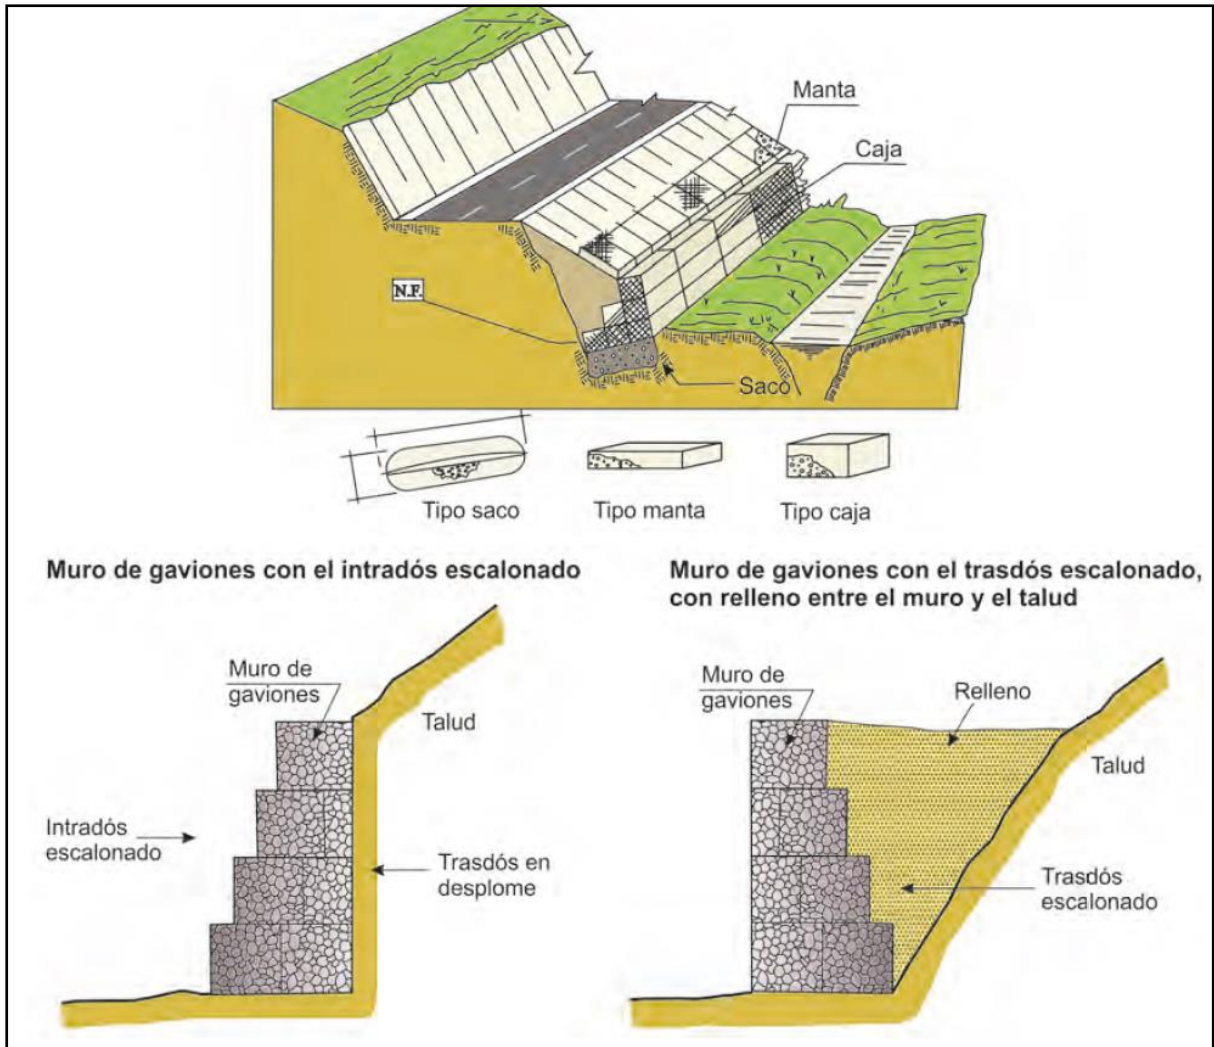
Muro de gaviones y ejemplos de aplicación, (Vilches, 2021)
